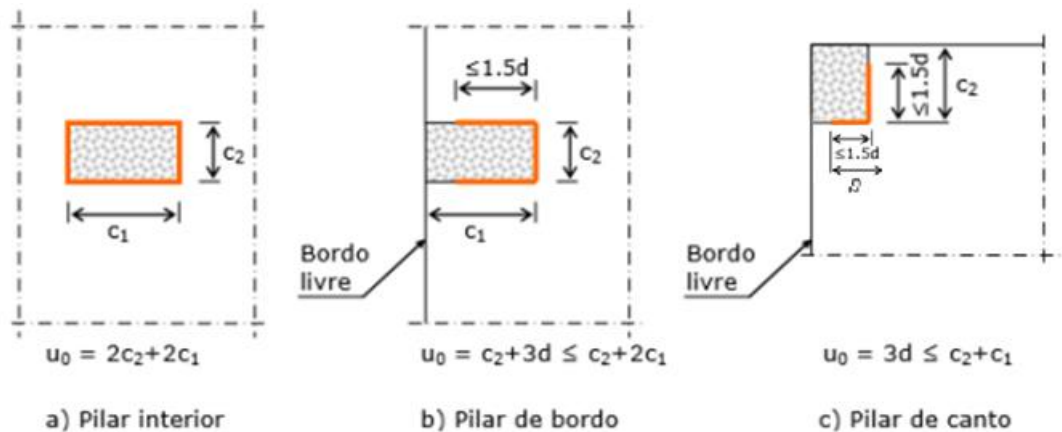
Perímetro de controlo para: a) pilar interior, b) pilar de bordo e c) pilar de canto (Félix, 2010b)
